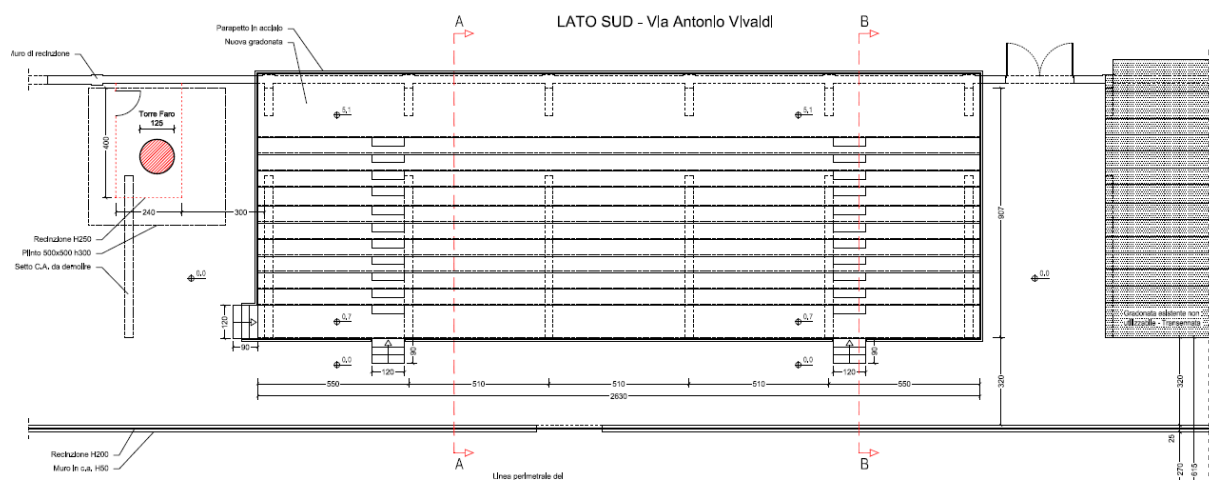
a-b: planimetria nuova tribuna ospiti (Tav. 04)
